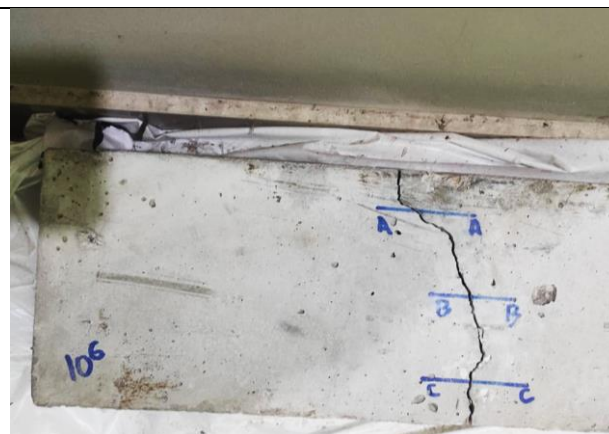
Viga de bioconcreto 1×10^6 cel/ml fisurada, después.
